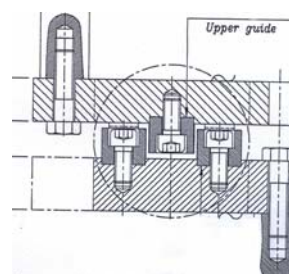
Schéma des butées transversales métalliques / Diagram of steel transverse stoppers
